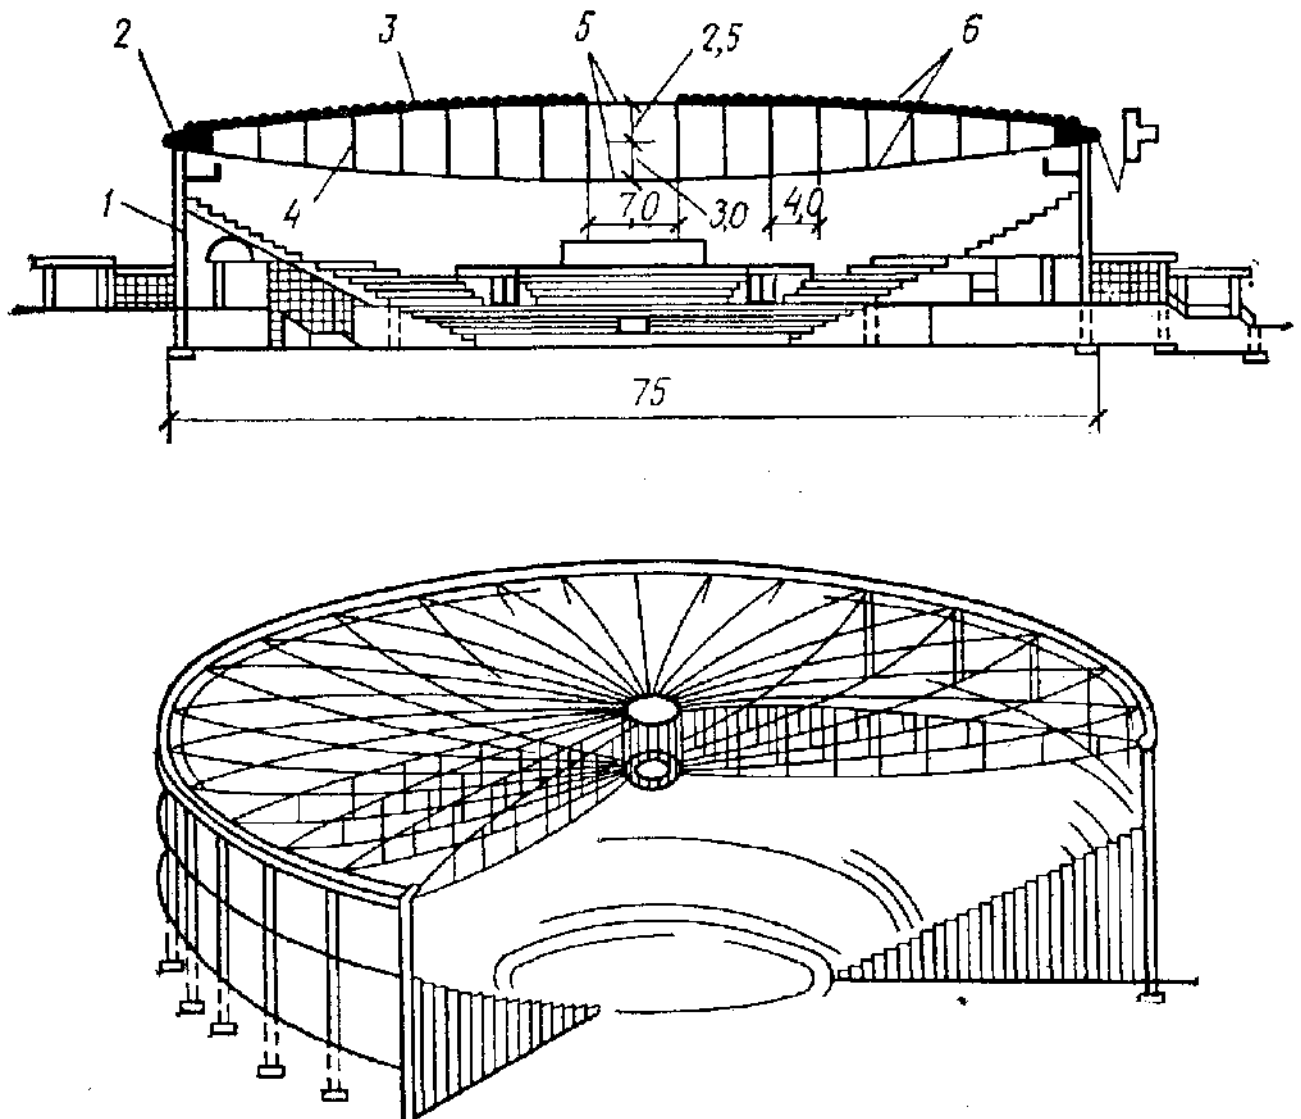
Покрытие аудитории в г. Утике (США): 1 – железобетонная колонна; 2 – железобетонное опорное кольцо; 3 – покрытие по плитам из волнистой стали; 4 – распорная стойка; 5 – стальные кольца; 6 – предварительно напряженные тросы (по 72 шт.)
